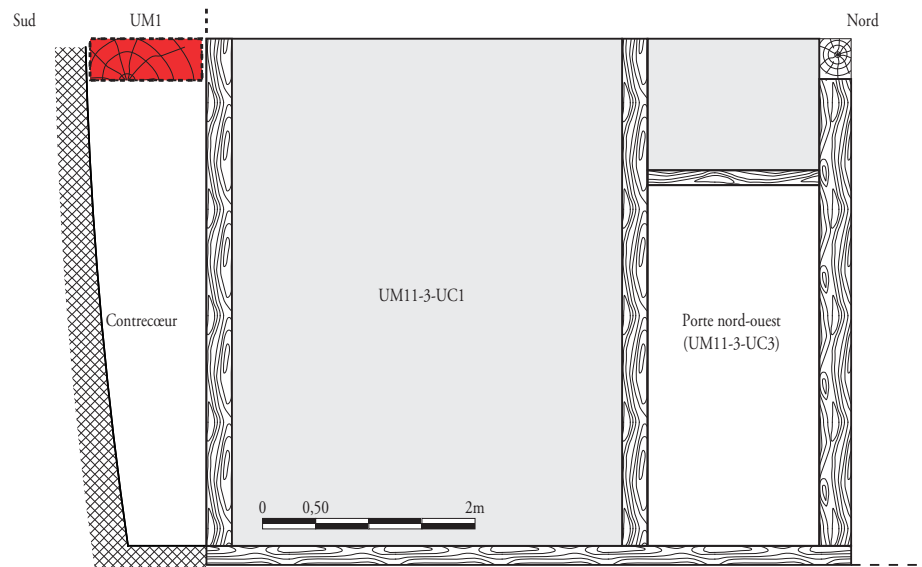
Coupe du conduit de cheminée et de la structure en pans de bois
